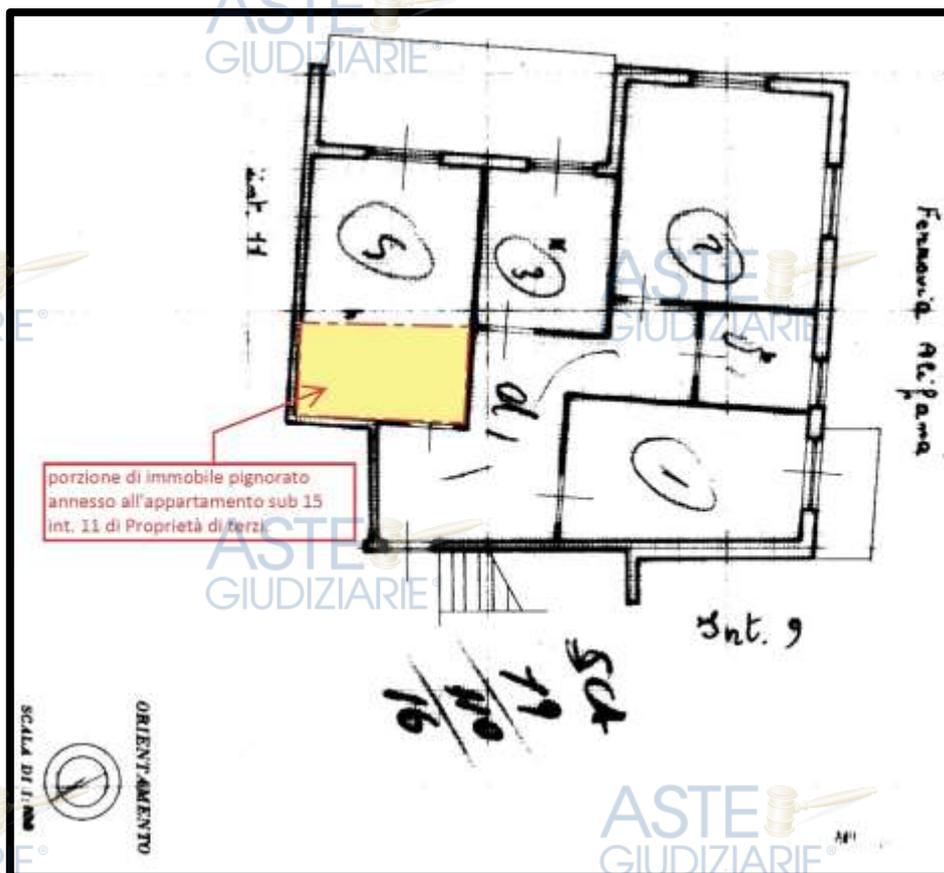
Stralcio dell'originaria Planimetria Catastale (fuori scala) dell'appartamento pignorato
